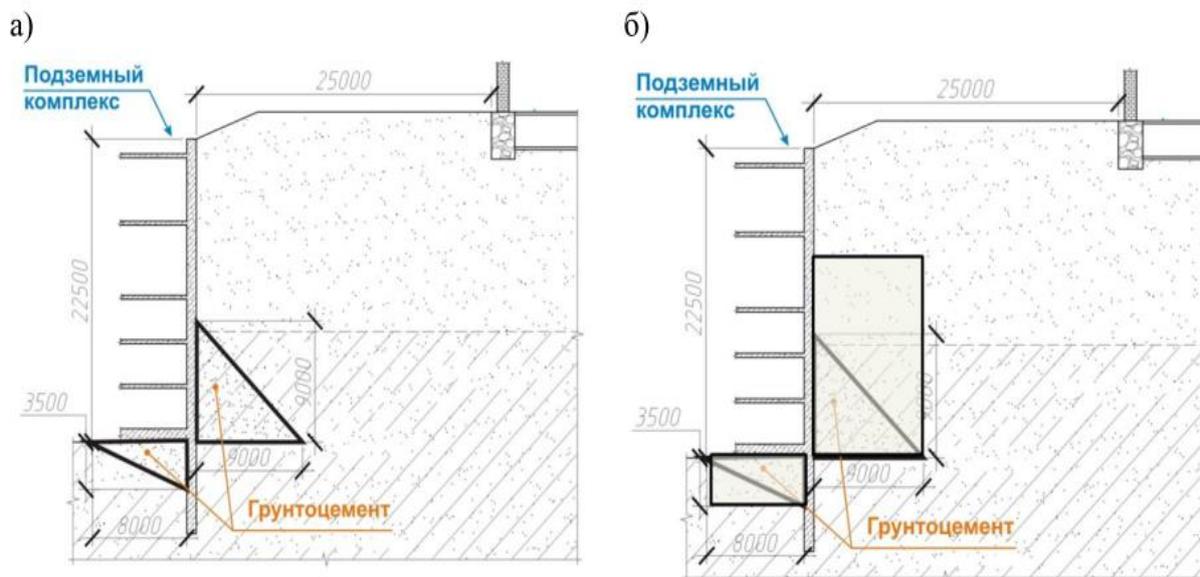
Конструктивные схемы откопки котлована: а - «сверху вниз» с поэтапным устройством всех (5 уровней) промежуточных перекрытий; б - «сверху вниз» с устройством только одного верхнего перекрытия
